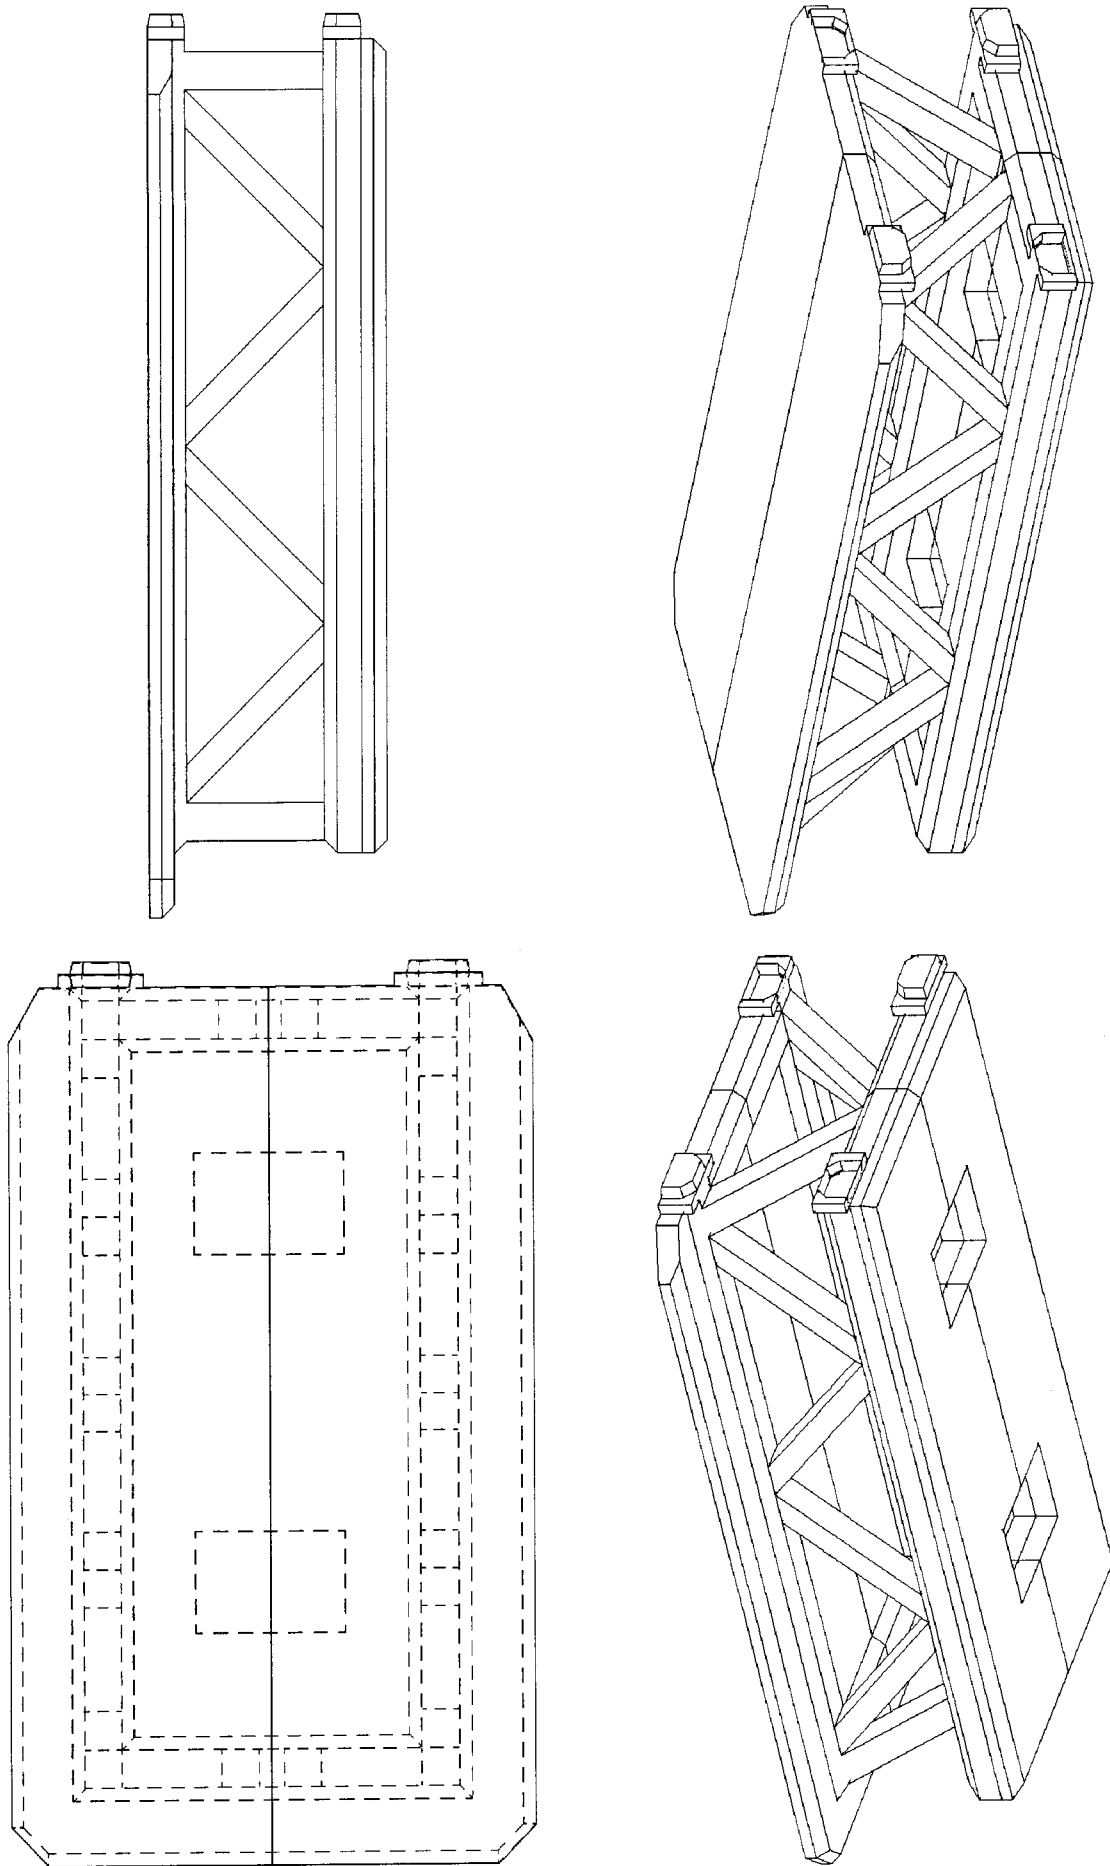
Módulo rectangular - Planta -Perfil - vistas 3D
